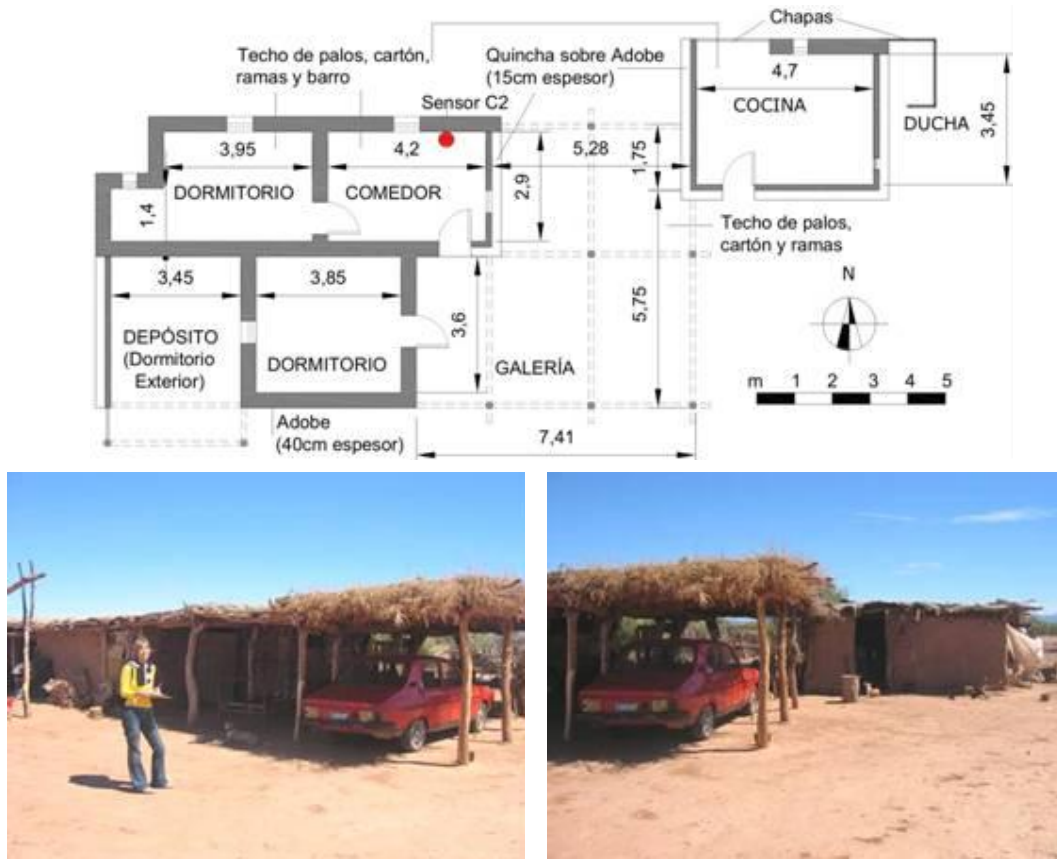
Planta y vistas de la vivienda monitoreada V2. Ubicación de sensor C2.
